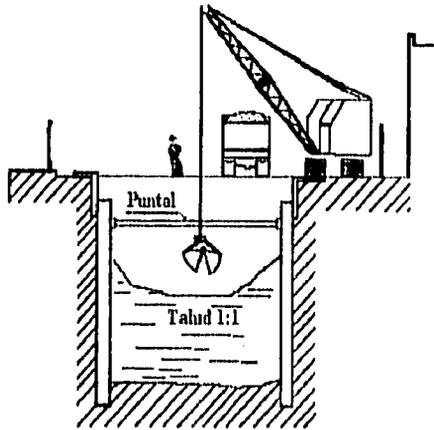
Excavación del núcleo y apuntalamiento alternado hasta alcanzar el nivel de proyecto.
